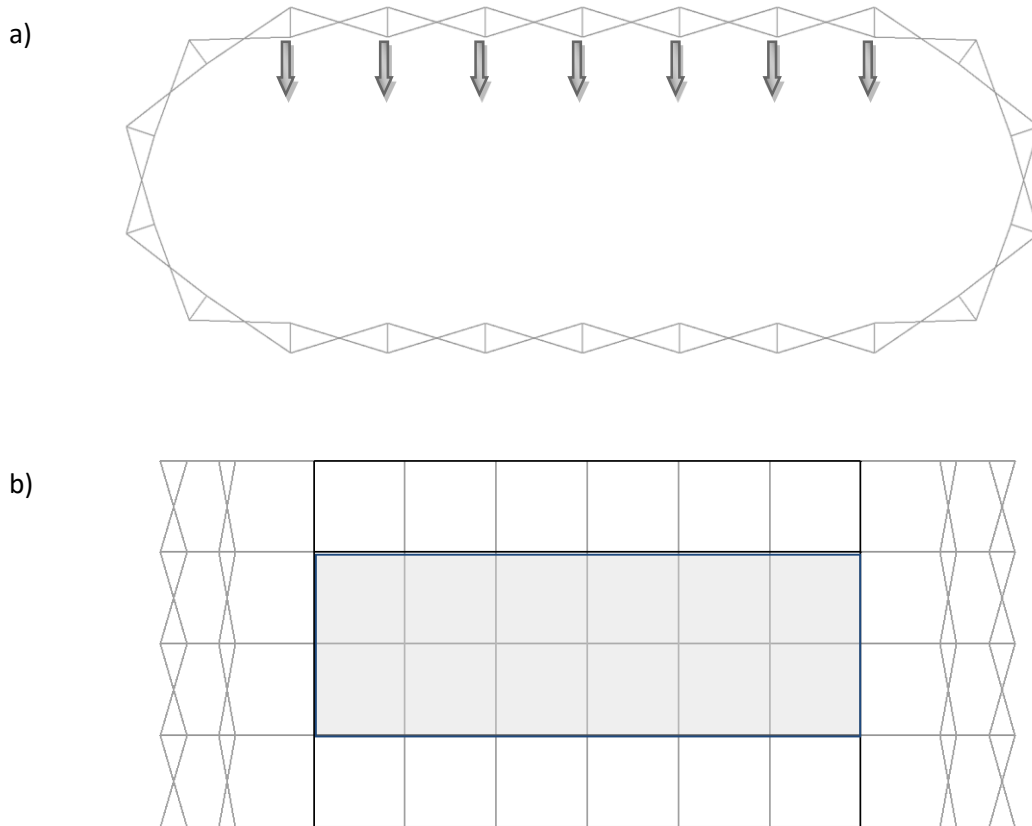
Cargas de instalaciones: a) alzado, b) planta
